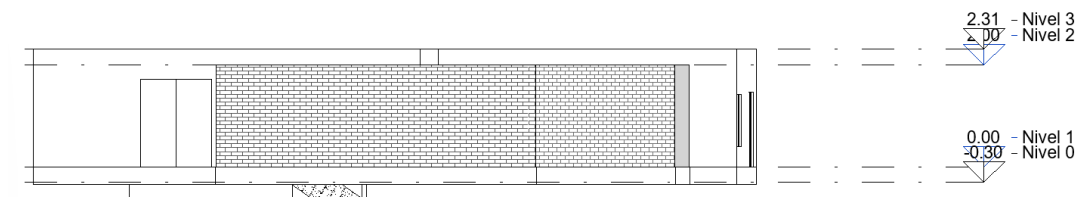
Alzado Oeste modelo levantamiento con Cámara 360°. Fuente: elaboración propia.
